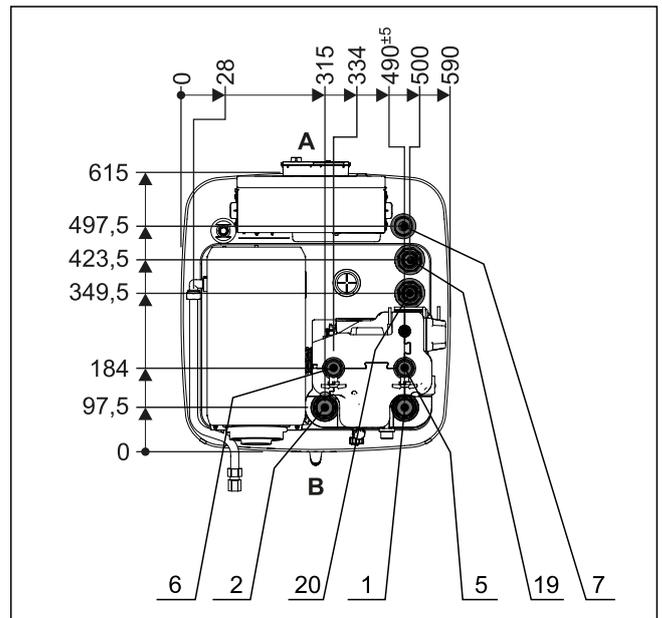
Anschlussmaße GCU compact 3xx (Draufsicht)
